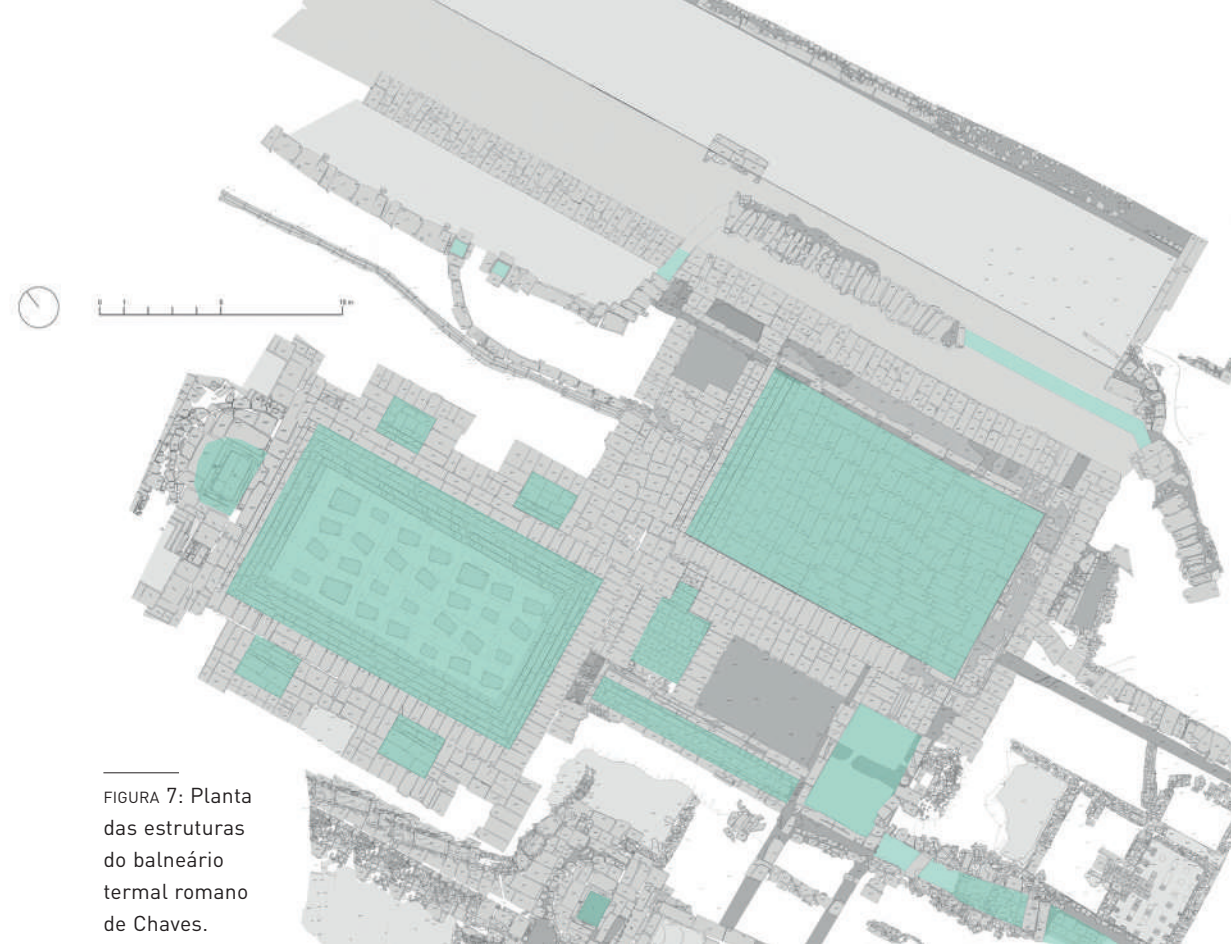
Planta das estruturas do balneário termal romano de Chaves.
